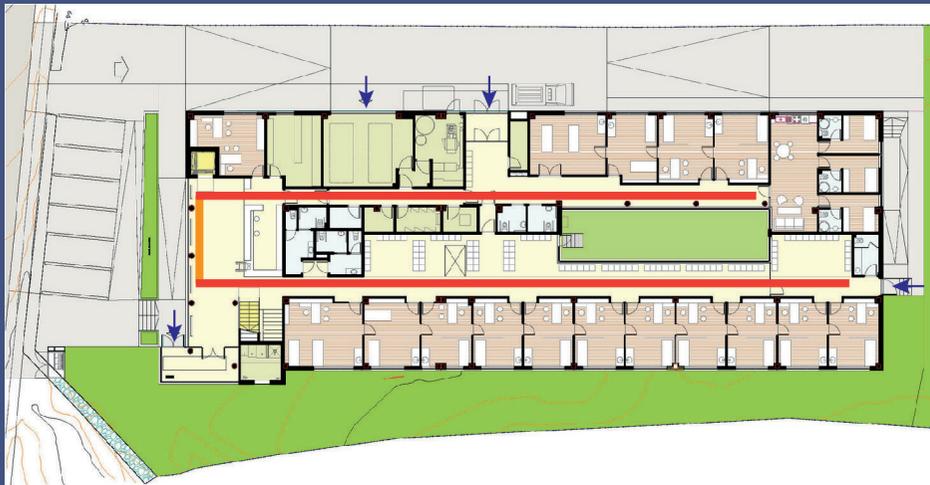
Accesos y circulación en la planta baja. Elaboración propia en base a Plataforma arquitectura (2021)
